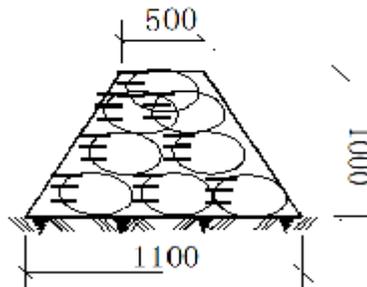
土袋临时拦挡典型断面设计图 (单位: mm)
